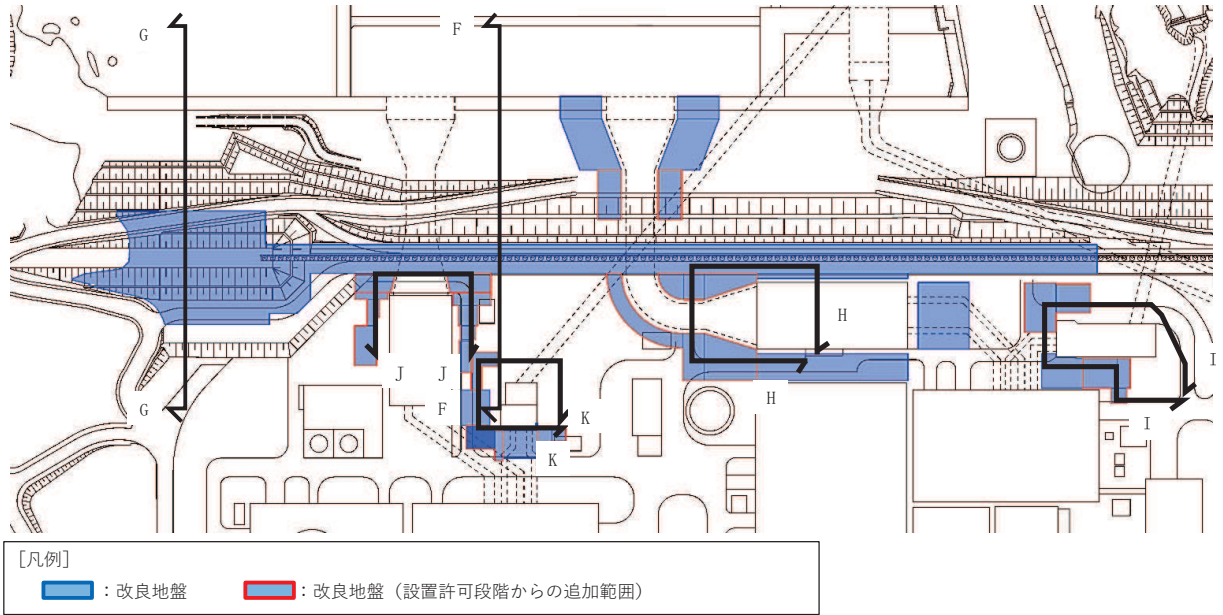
地盤改良体の平面配置図 (防潮堤, 防潮壁, 防潮堤 (第 3 号機取水路横断面))
